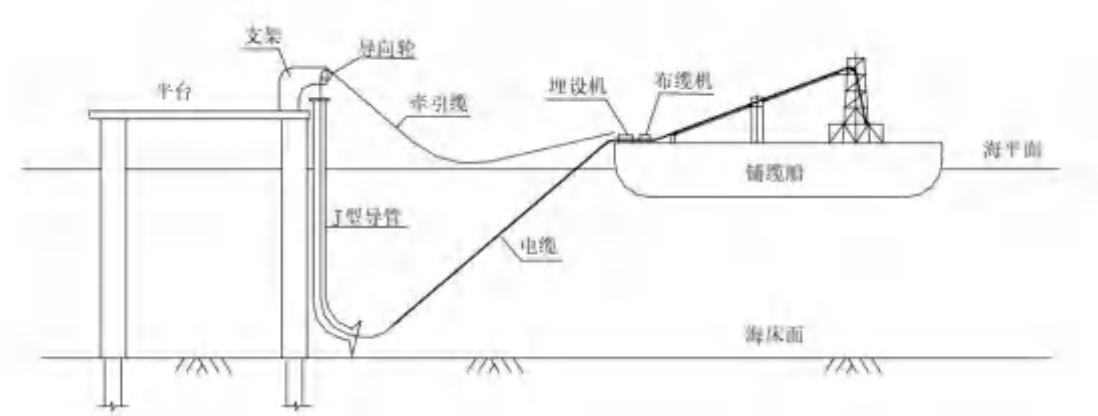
电缆起始端上平台/风机铺设施工示意图
